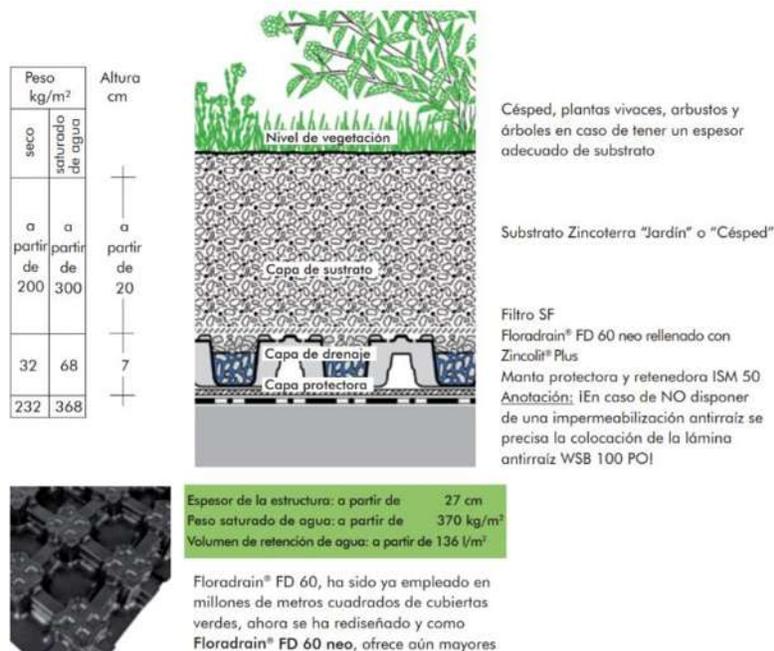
| Sistema de cubierta verde intensiva con un sistema tipo jardín. FUENTE I (LIFE ON ZINCO ROOFS CUBIERTAS VERDES INTENSIVAS, 2018)
